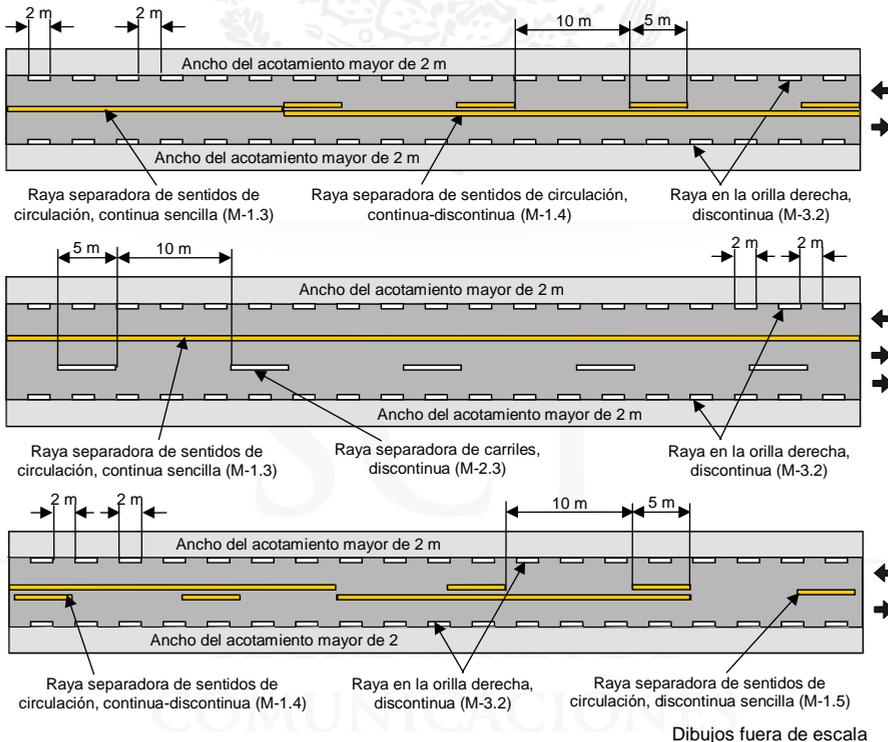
Marcas en el pavimento en carreteras con ancho de arroyo vial mayor de 6,5 m
